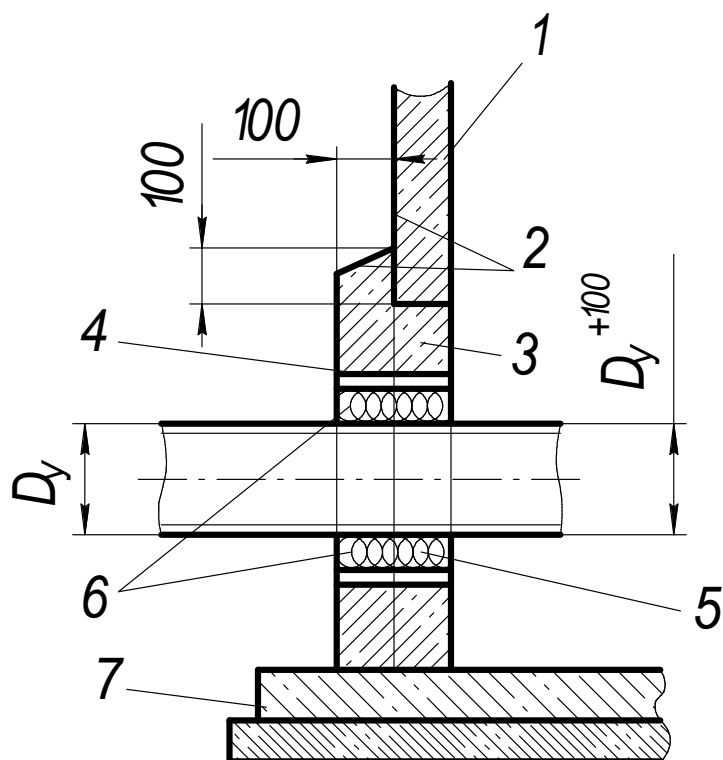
Деталь заделки труб в стенах колодцев, сооружаемых в мокрых грунтах: 1- стеновое кольцо, 2 – покрытие горячим битумом за два раза, 3 – бетон, 4 – стальной патрубко-футляр, 5 – асбестоцементный раствор, 6 – просмоленный канат, 7 – плита-днище
